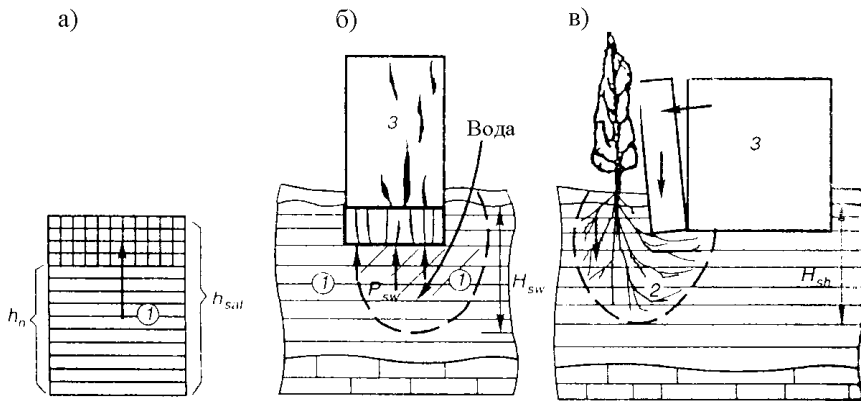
Схема набухания грунта (а), давление набухания (P_{sw}) на фундамент (б) и деформации здания от усадки грунта (в):
